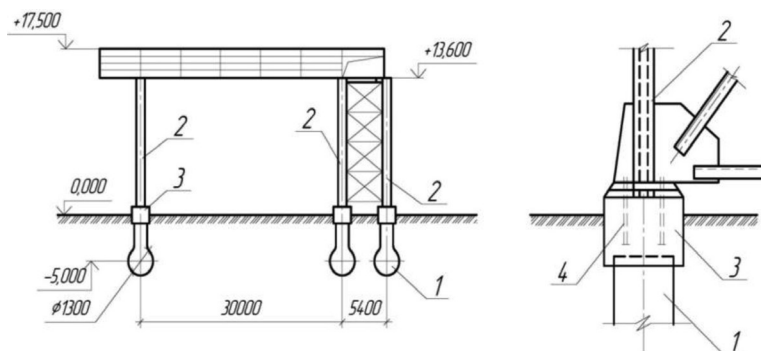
Односвайный фундамент под шинопровод аглофабрики № 2:
